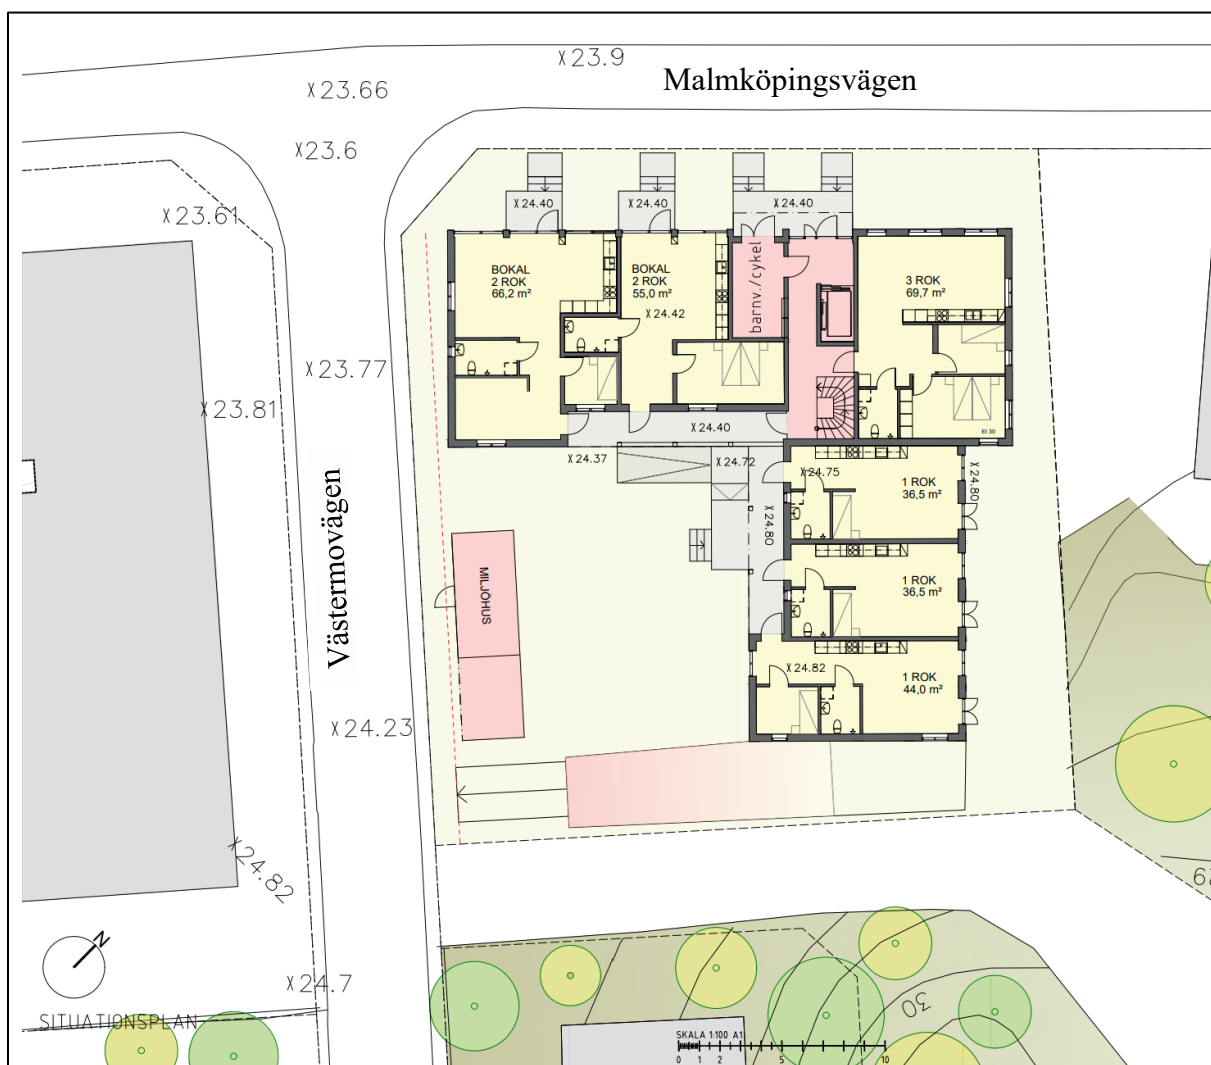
visar situationsplan för flerbostadshuset med den nya planlösningen
